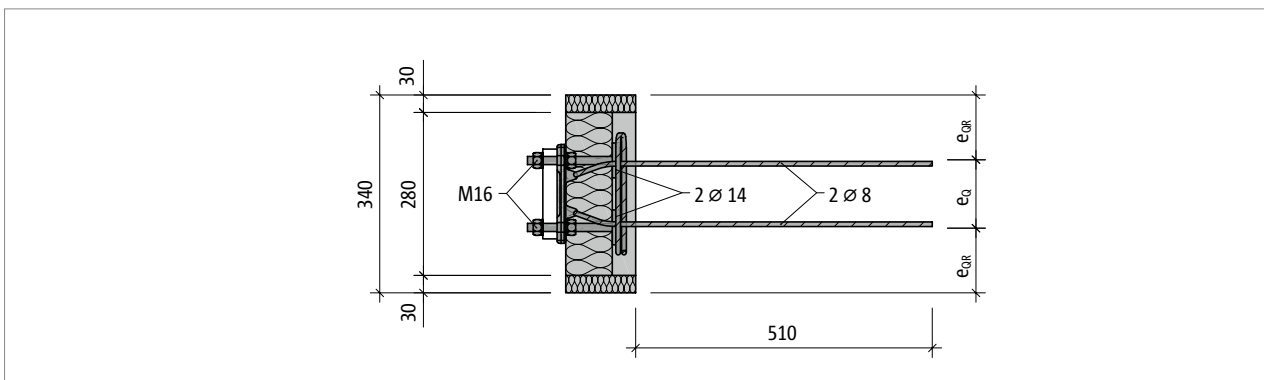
Schöck Isokorb® RT Typ SQ-V1: Produktgrundriss
